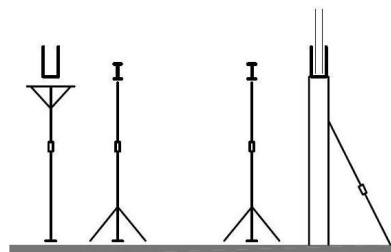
figura esquemática do escoramento do vigamento principal das lajes
